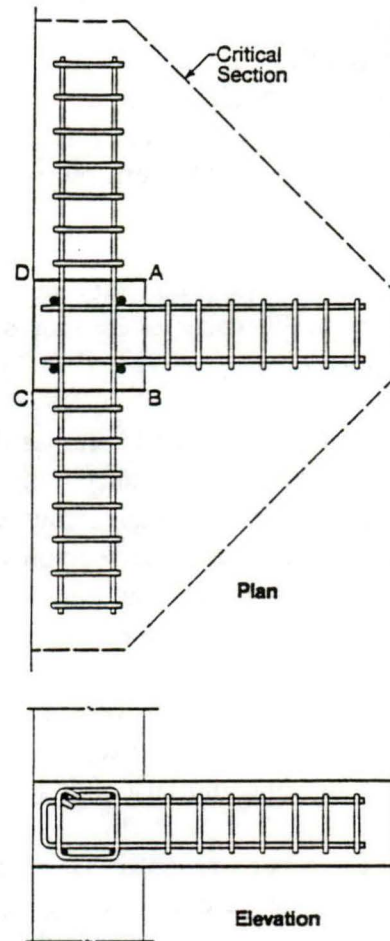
(c) Disposición de estribos de corte, columna de borde.
